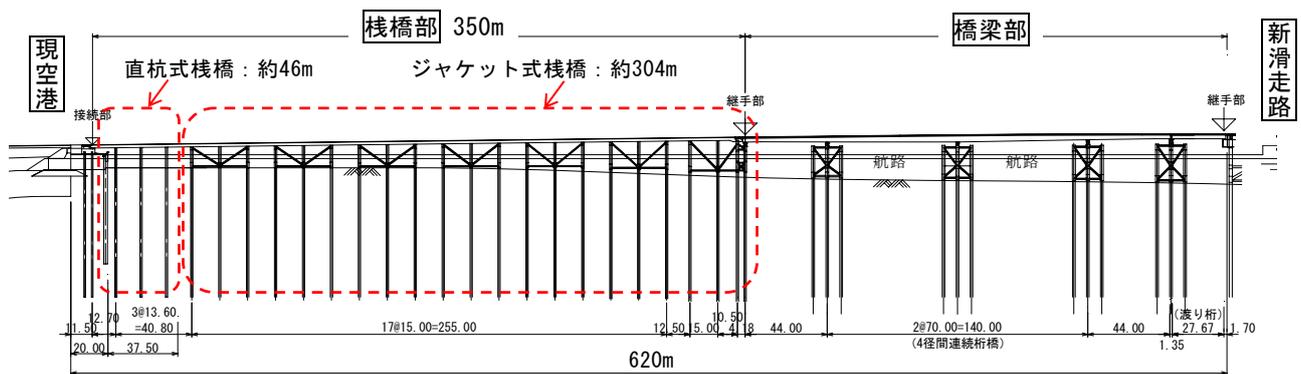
連絡誘導路 側面図 (図-1のA-A断面)
